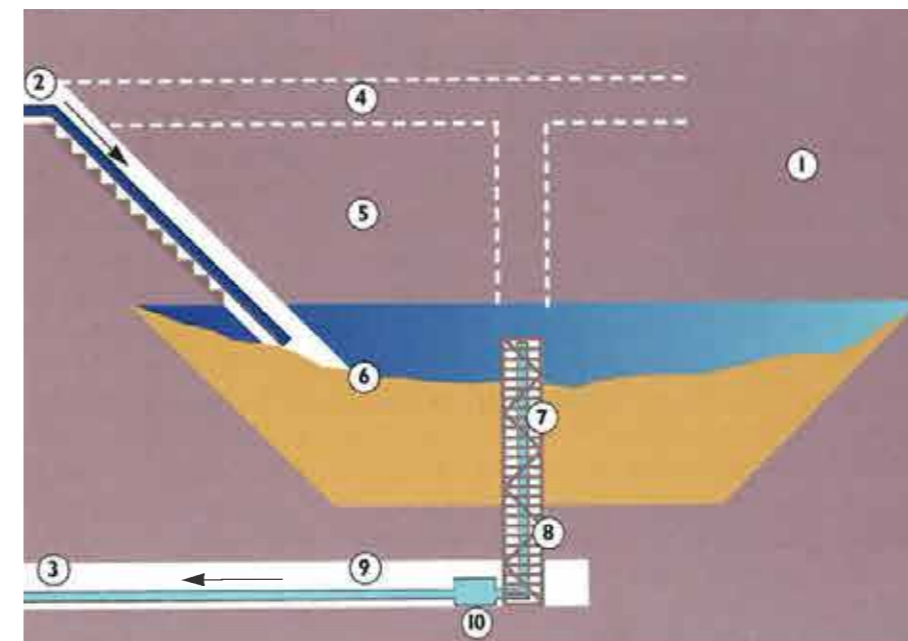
Schemaschnitt durch eine Laugwerksanlage (Ablasswerk)
